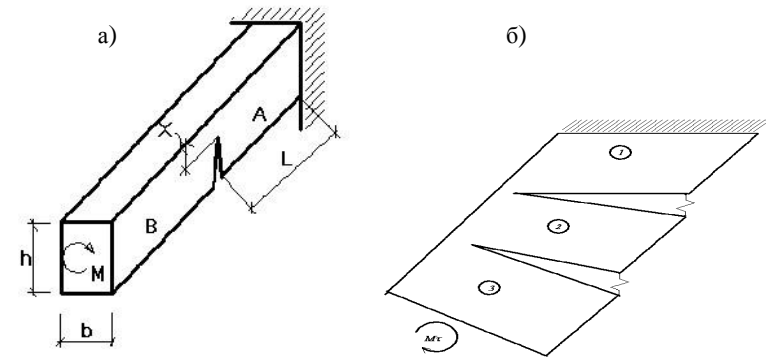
а-схема залізобетонного елемента, що закручується, з нормальними тріщинами; б- схема деформування залізобетонного елемента з нормальними тріщинами при крутінні
